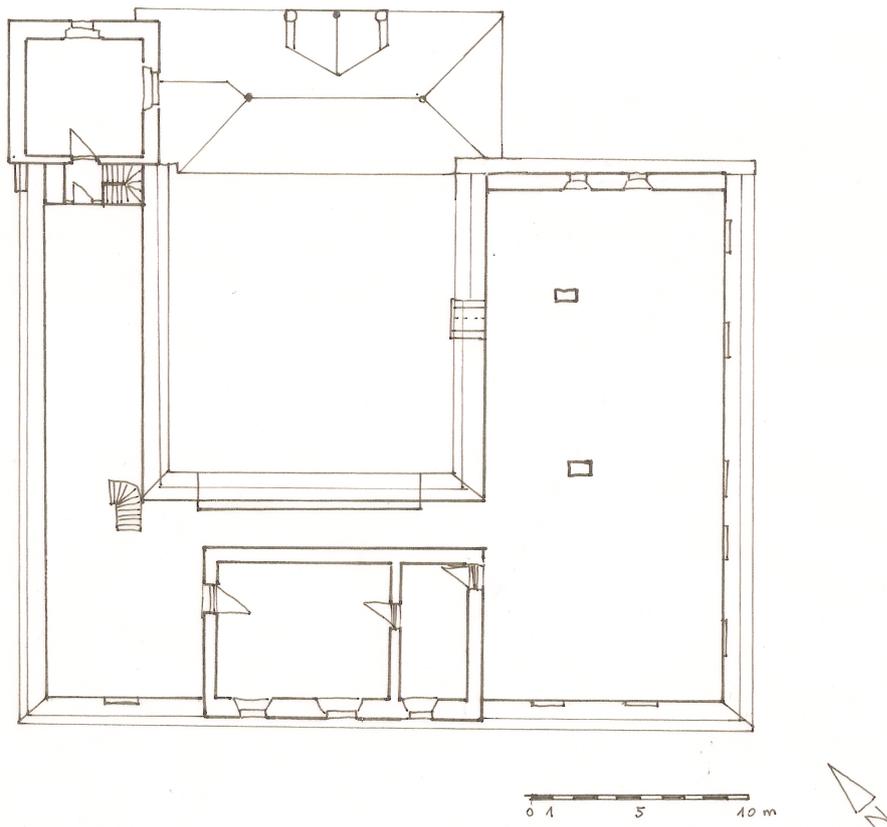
Grundriss 2.Obergeschoß und Dach
